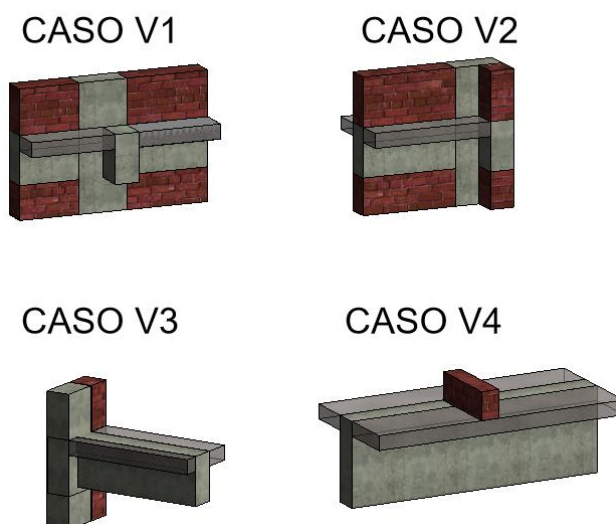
Vigas do segundo pavimento a serem reforçadas
